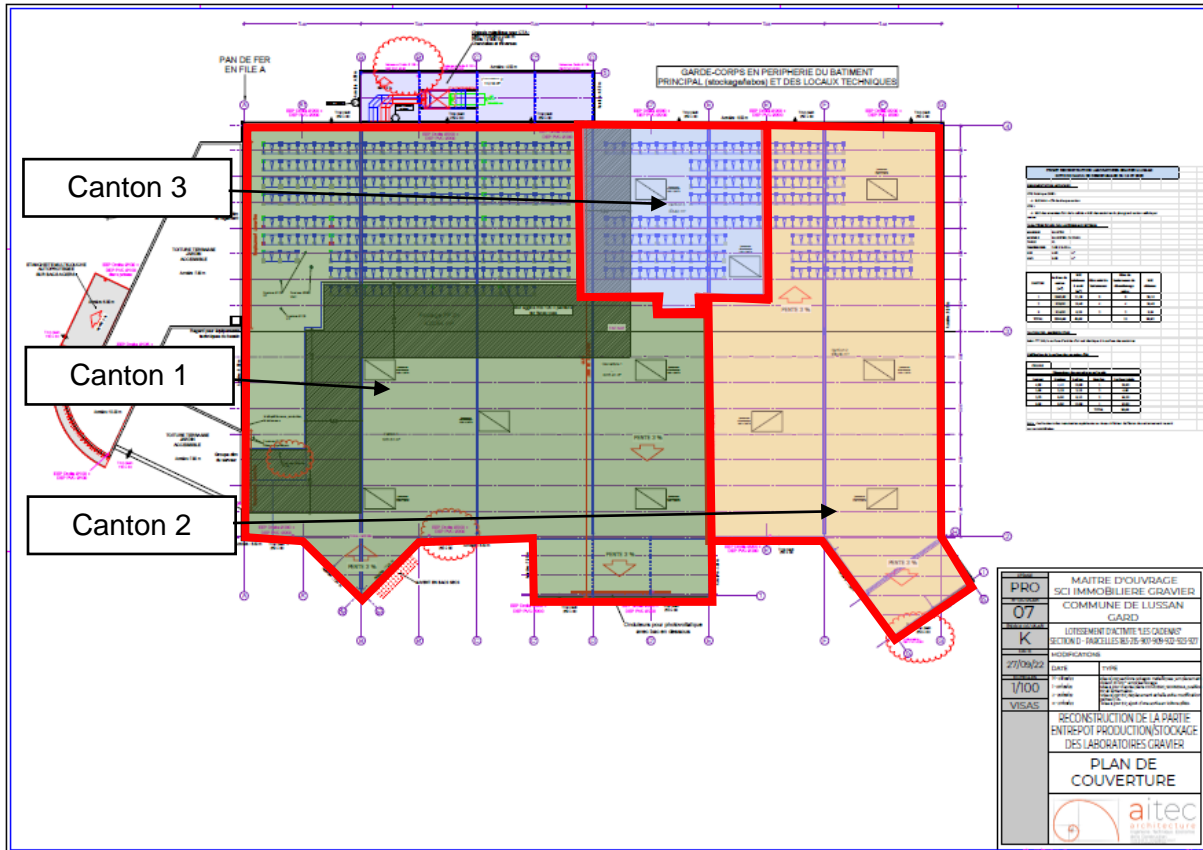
Plan de localisation des cantonnements (source : Cabinet AITEC)
